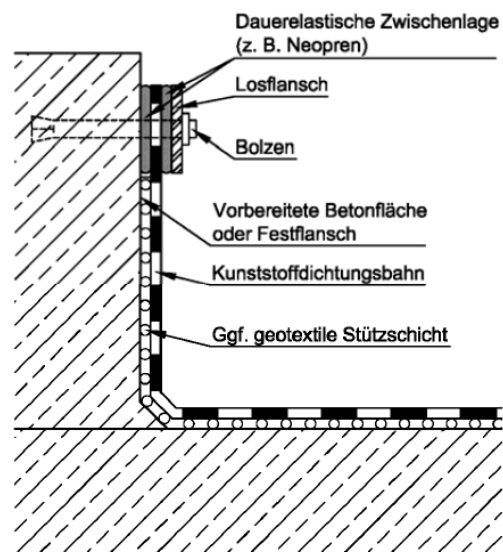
Anschluss einer Dichtungsbahn an eine Betonwand mittels einer Klemmverbindung⁶⁵
